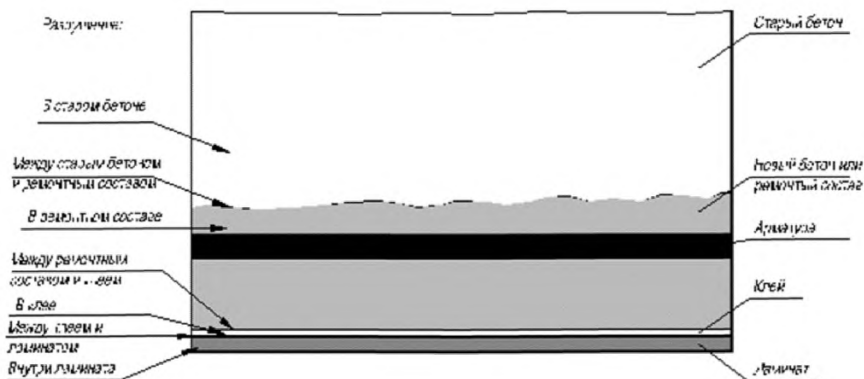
Возможные поверхности разрушения усиливаемой (ремонтируемой) железобетонной конструкции
